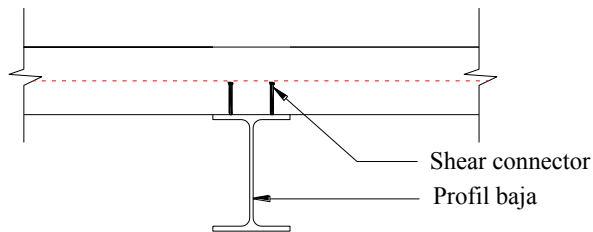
2 Balok baja tanpa diselubungi beton (*Setiawan, 2008*)
